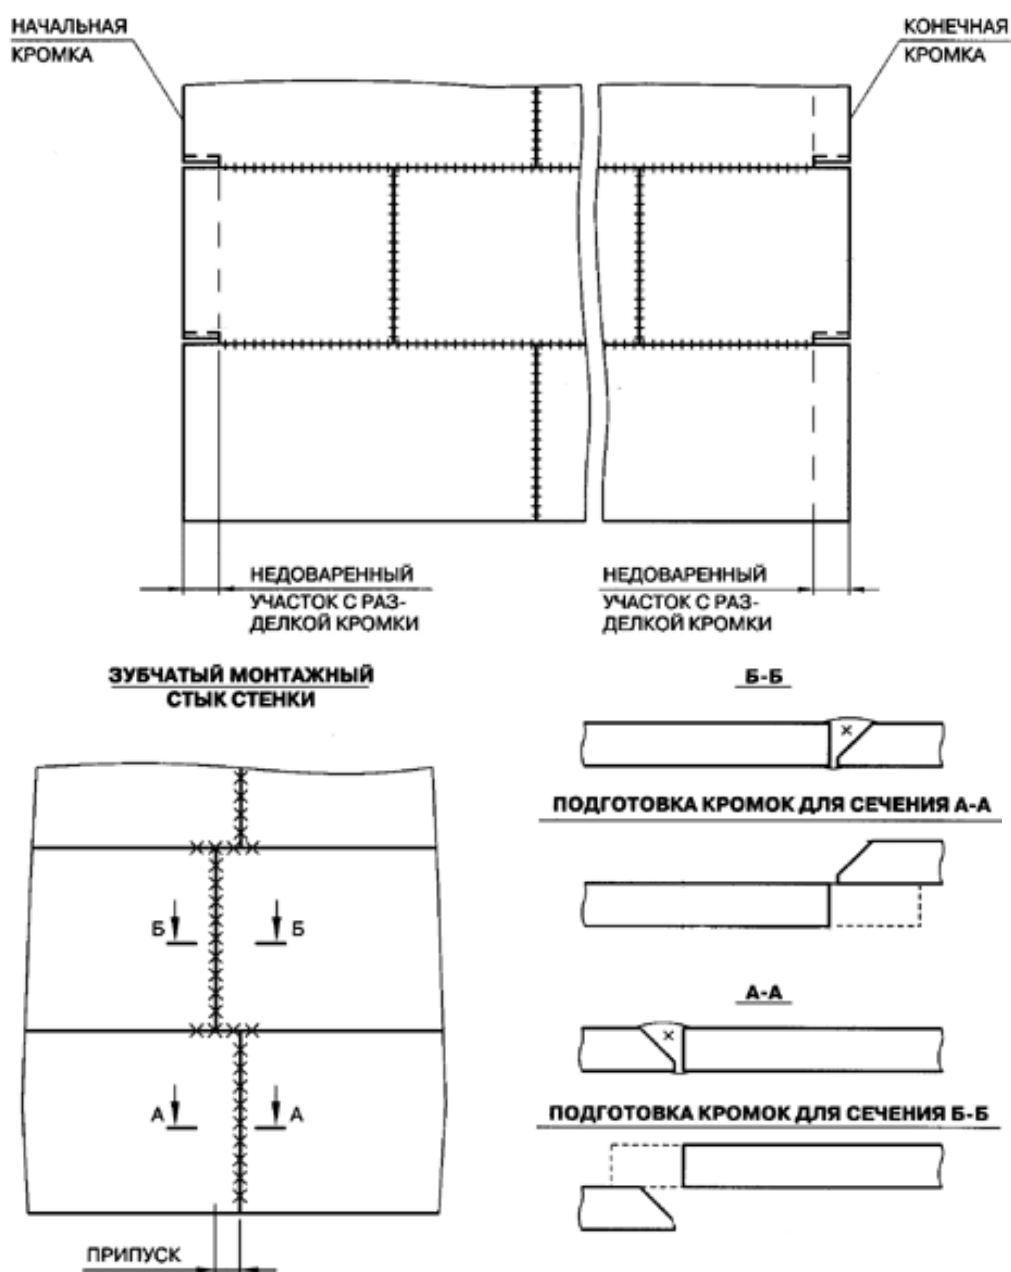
Разделка кромок под сварку стыка стенки резервуара
